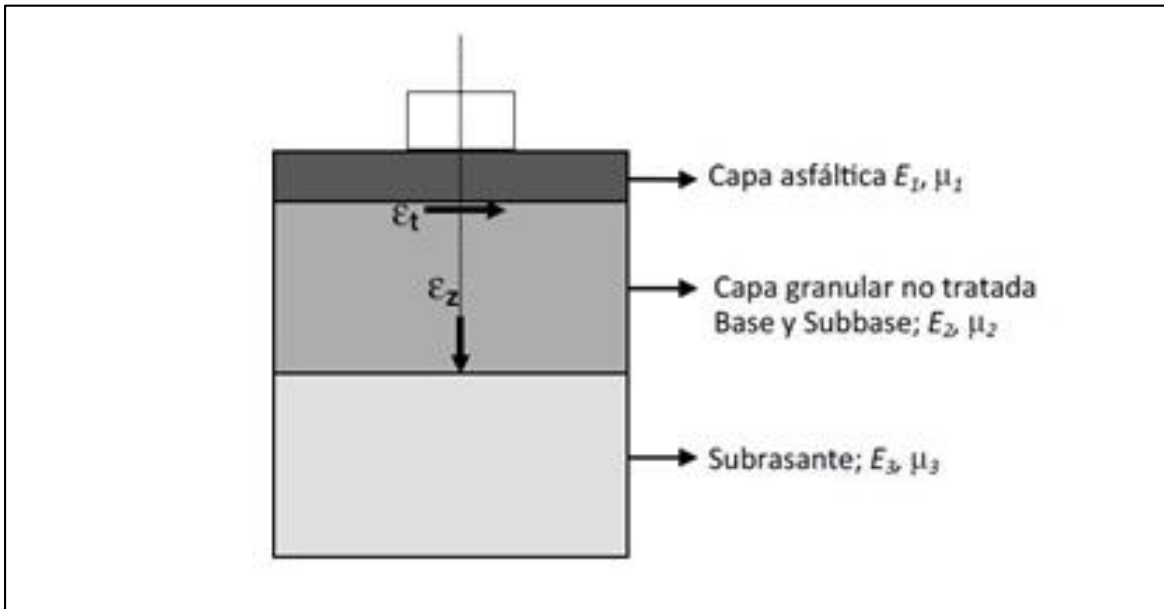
Diagrama del paquete estructural de un pavimento flexible.
